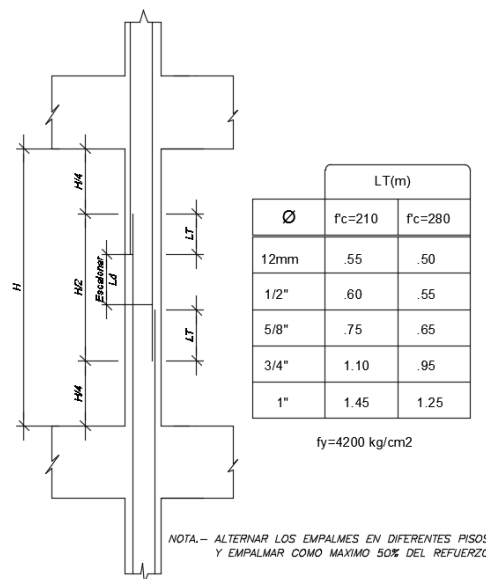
Consideraciones para el empalme del refuerzo en columnas
